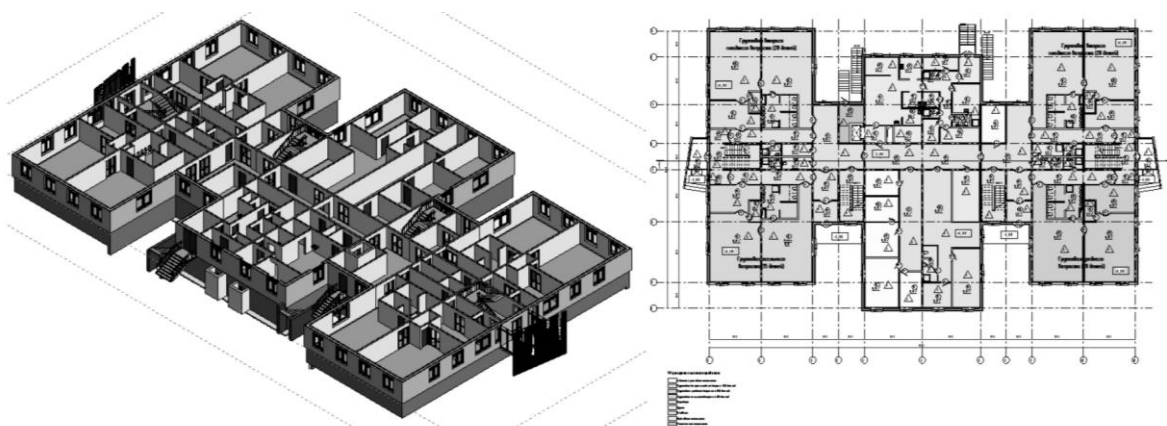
Трехмерное изображение модели здания и план этажа в Revit
